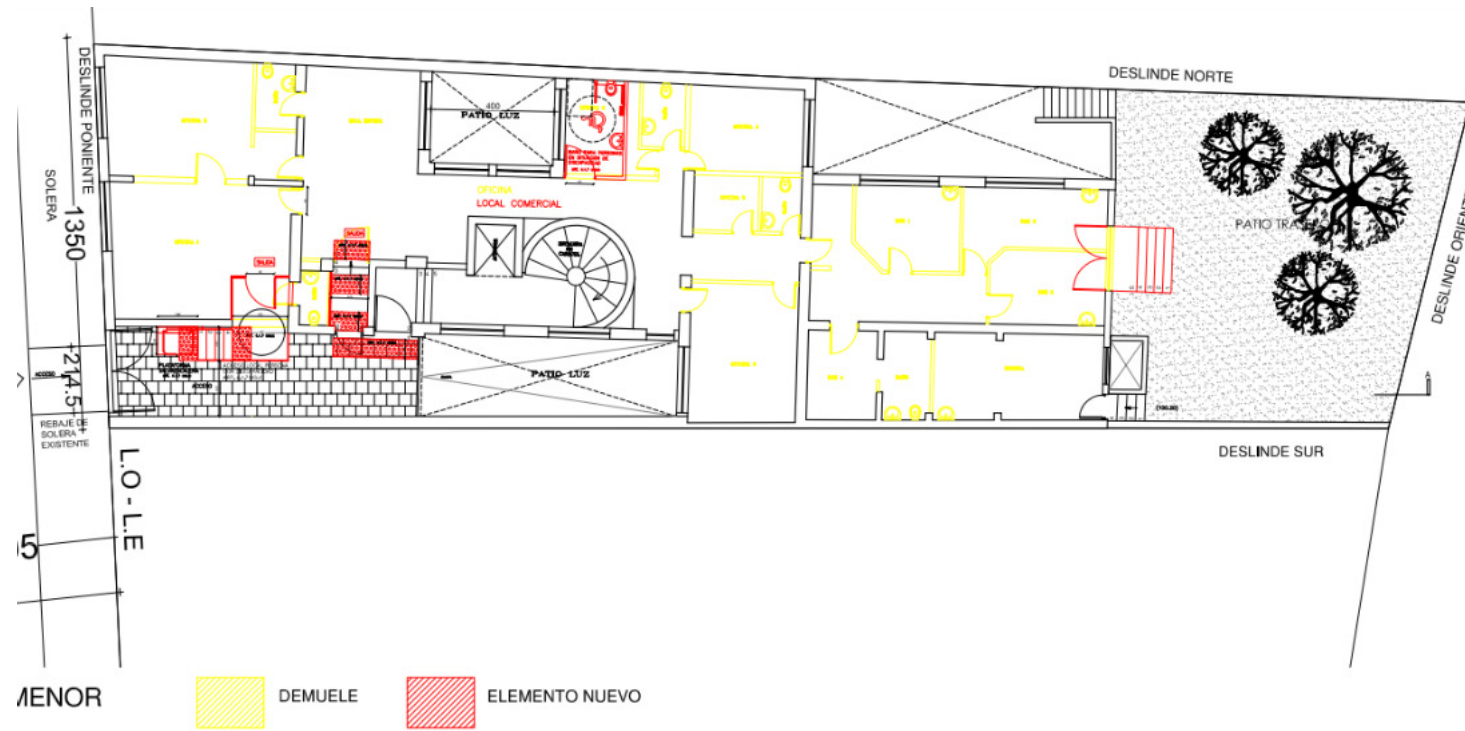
Ejemplo de estudio del entorno y planimetría – Fuente: Uno Proyectos
